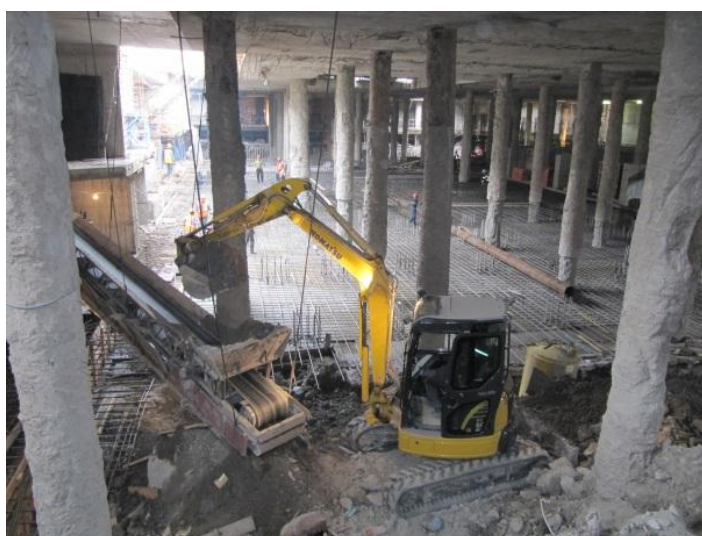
Разработка грунта под железобетонной плитой перекрытия на отметке – 11,10 м
